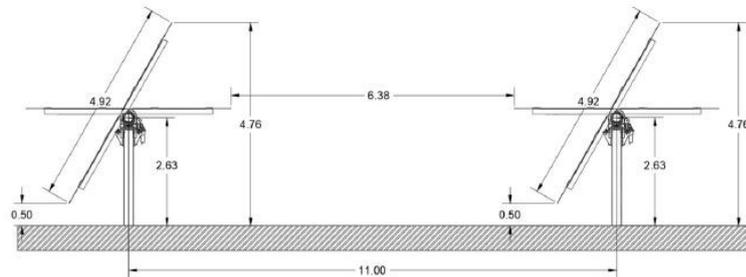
Sezione dell'area dell'impianto con indicazione delle scelte progettuali
